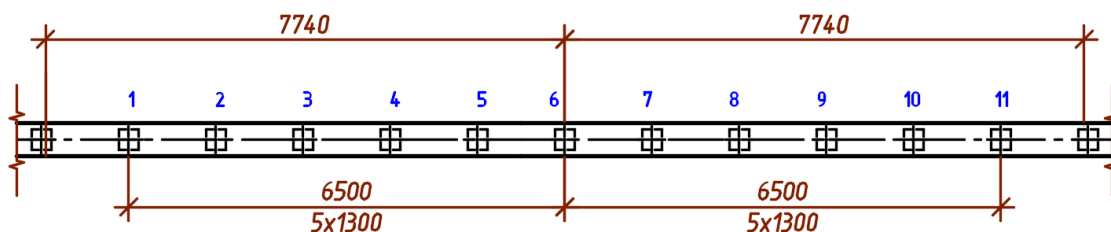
К расчету осадки свайного фундамента по оси Д
